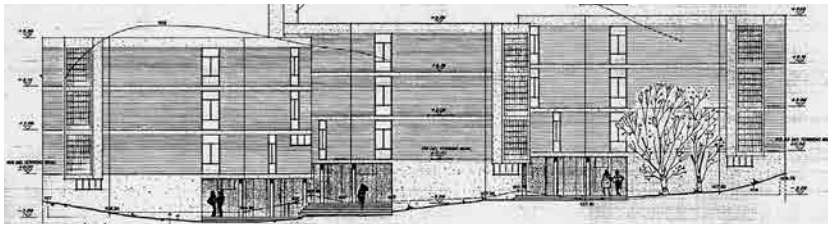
Alzado de la fachada principal del conjunto de residencias femeninas.
